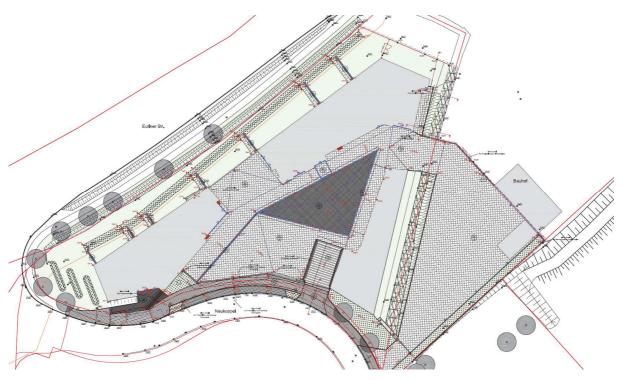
Lageplan (o. Maßstab) (IBUS Architekten)
